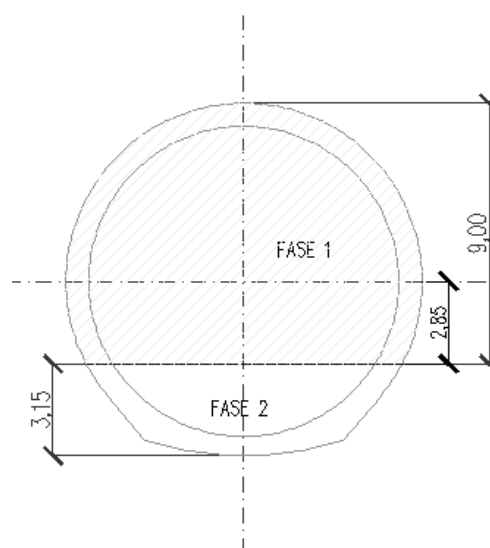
Perfil da escavação faseada da galeria em carga
